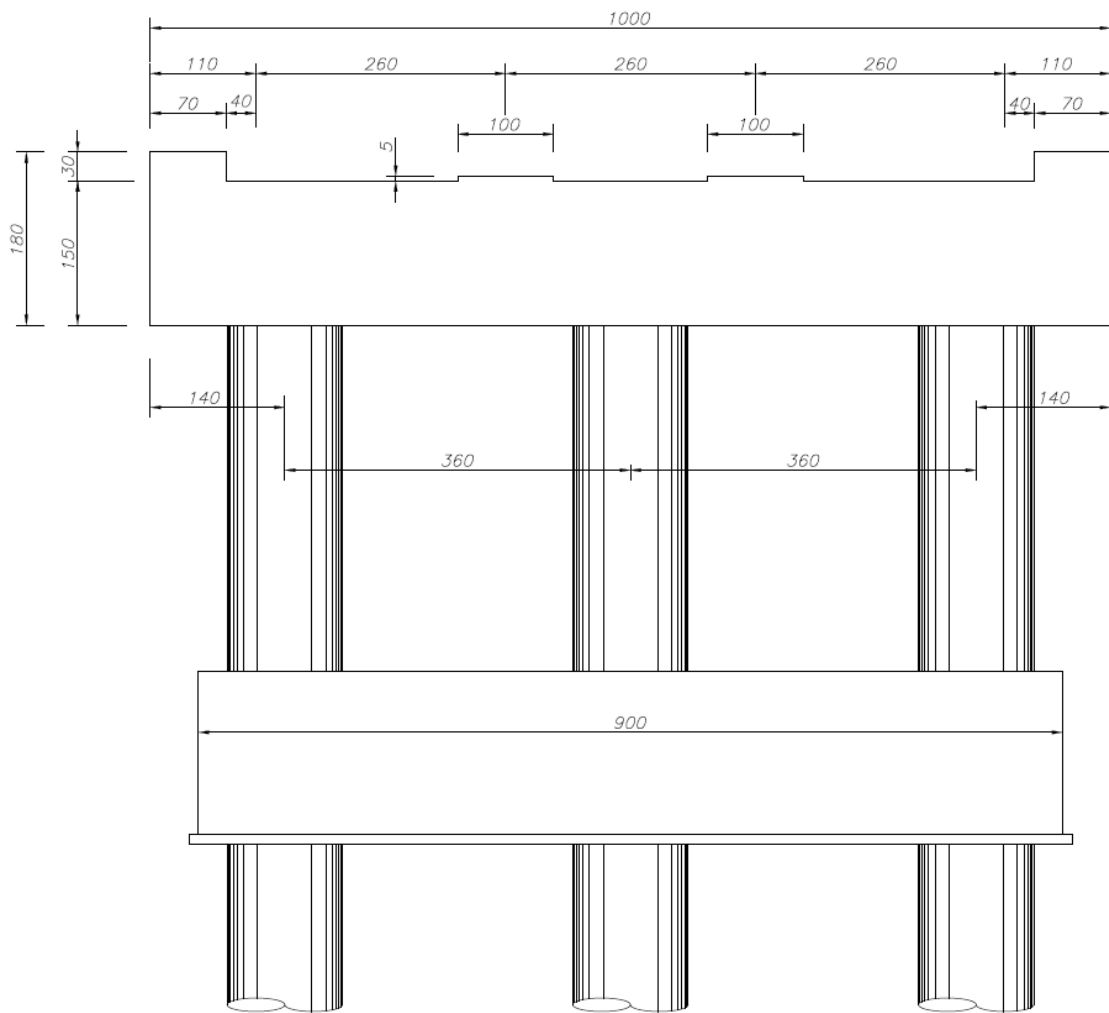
Elevación Frontal de Cepa Puente Águila Norte.
